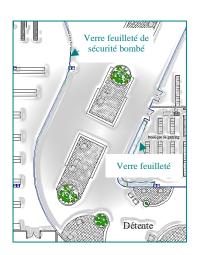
Vue en plan sur les vitrines. Source : Auteur
